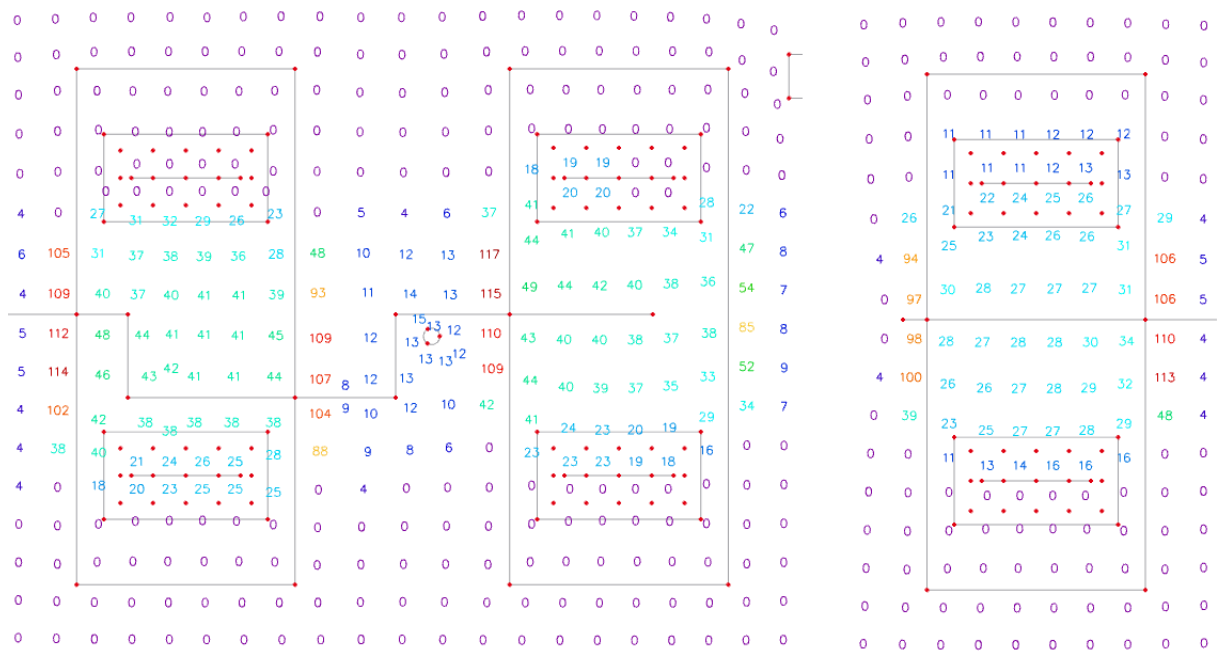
Nutná horní výztuž ve směru Y rovnoběžném s osou trámu [cm²/m]
